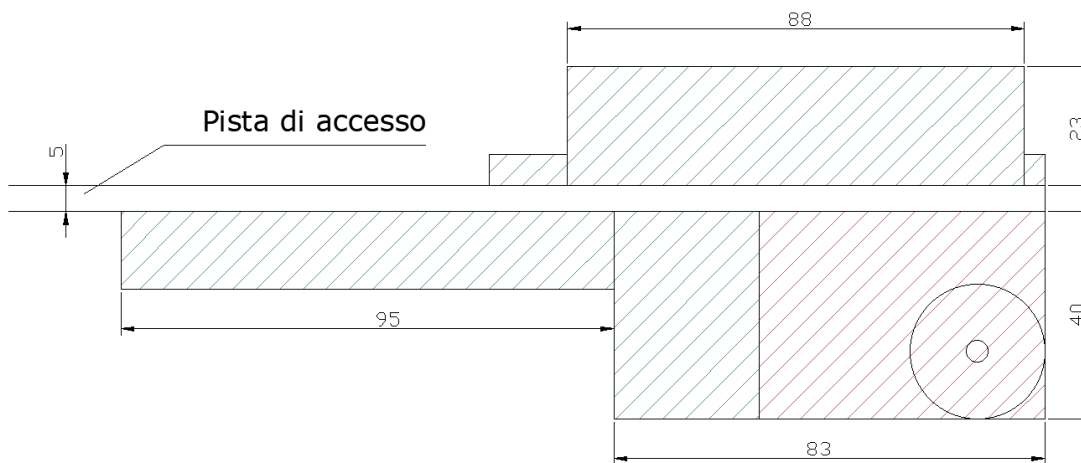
Tipico piazzola di cantiere con quote espresse in metri
